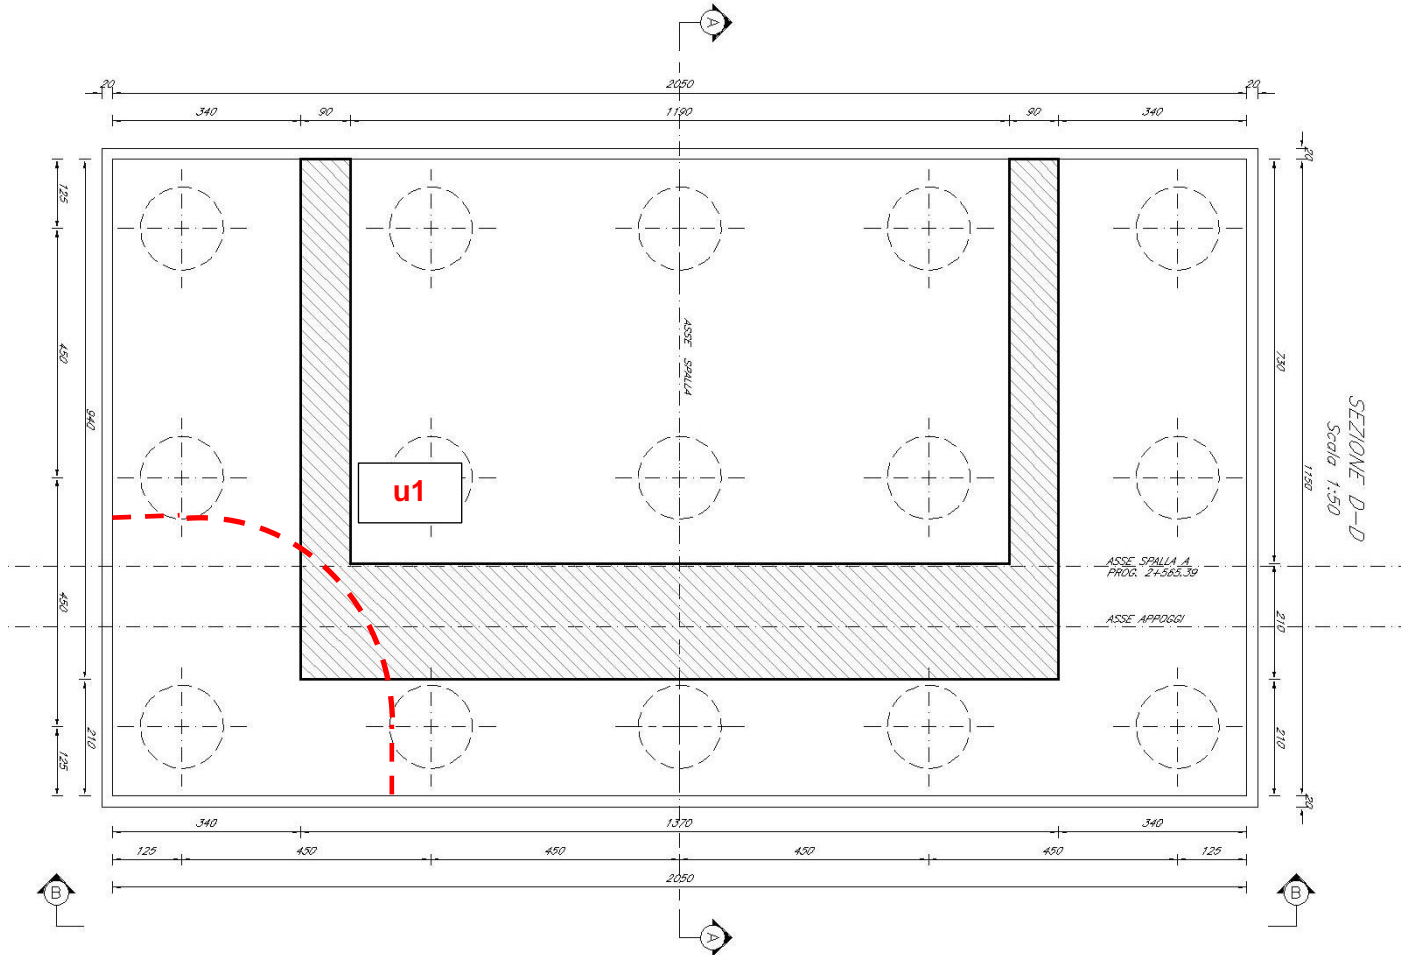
Plinto di fondazione – perimetro efficace per verifica a punzonamento per azione verticale trasmessa dal palo di spigolo
